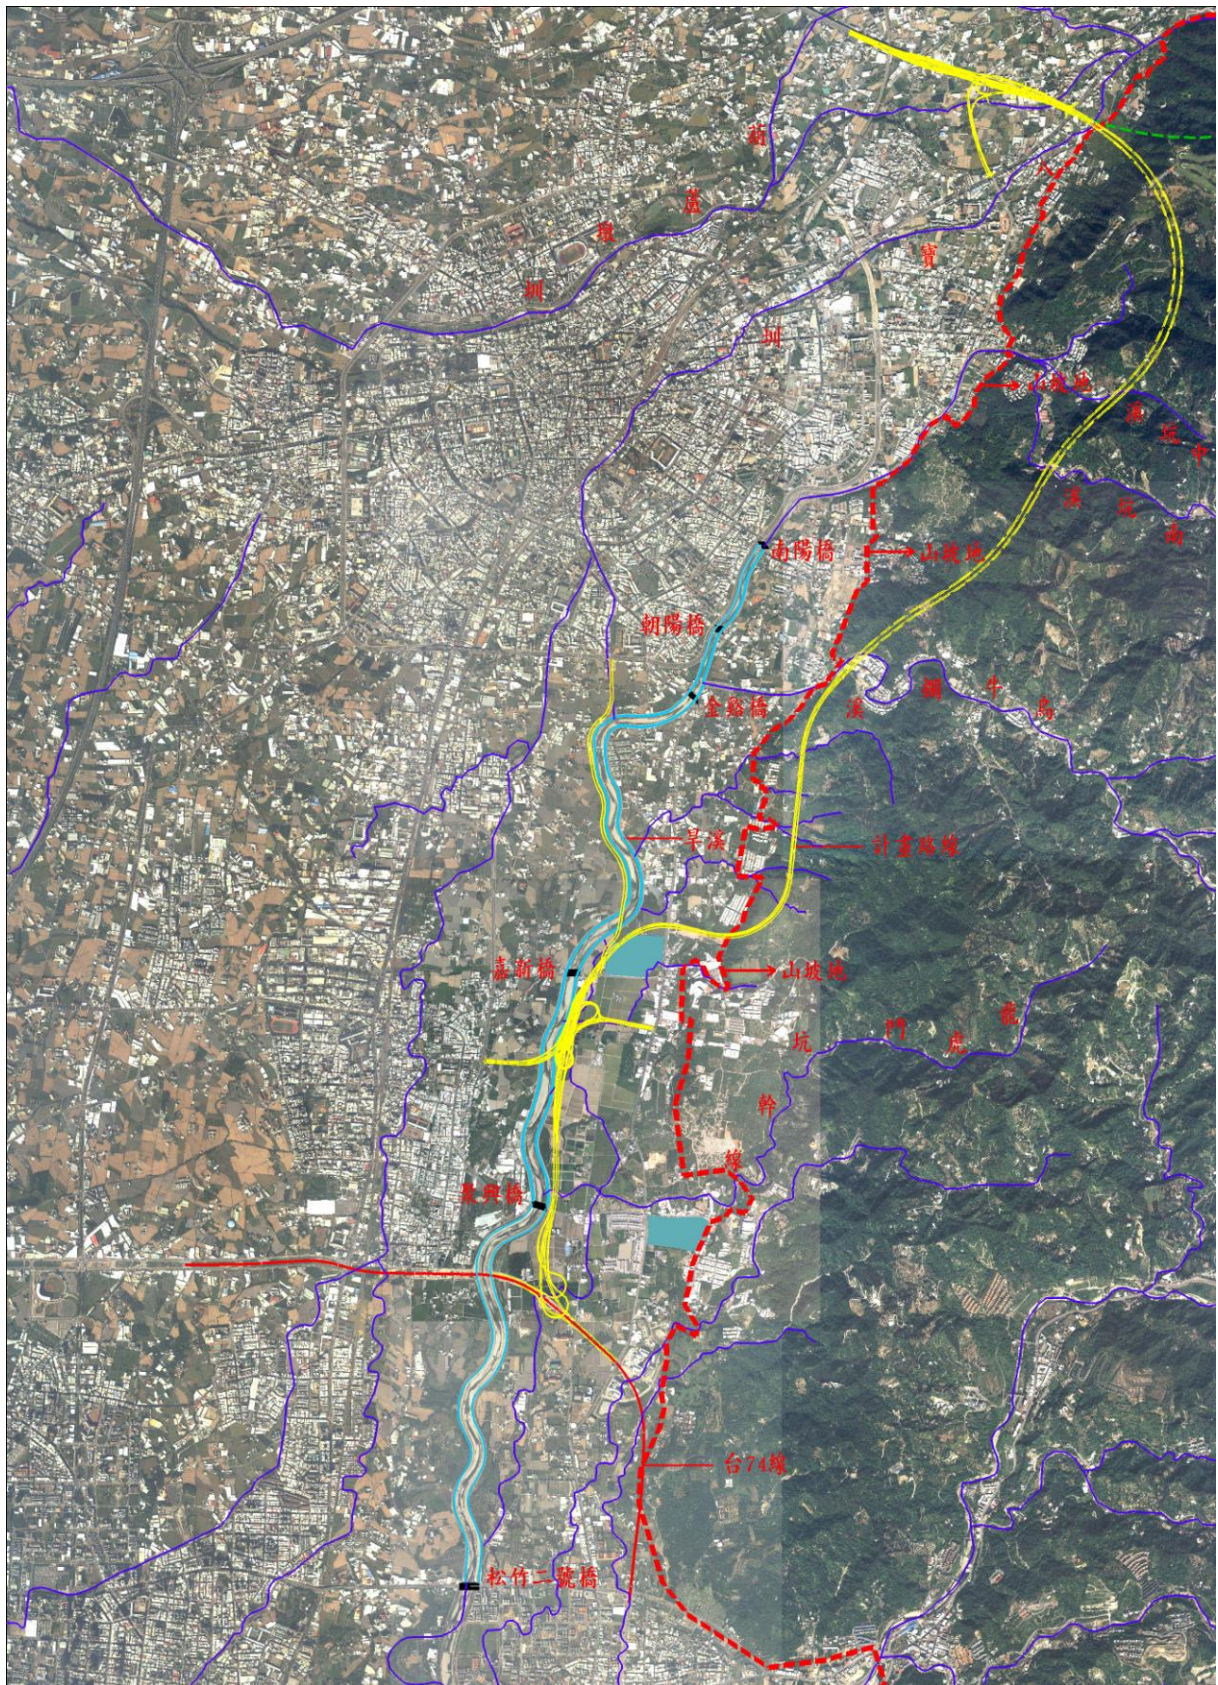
計畫路廊山坡地範圍平面圖
